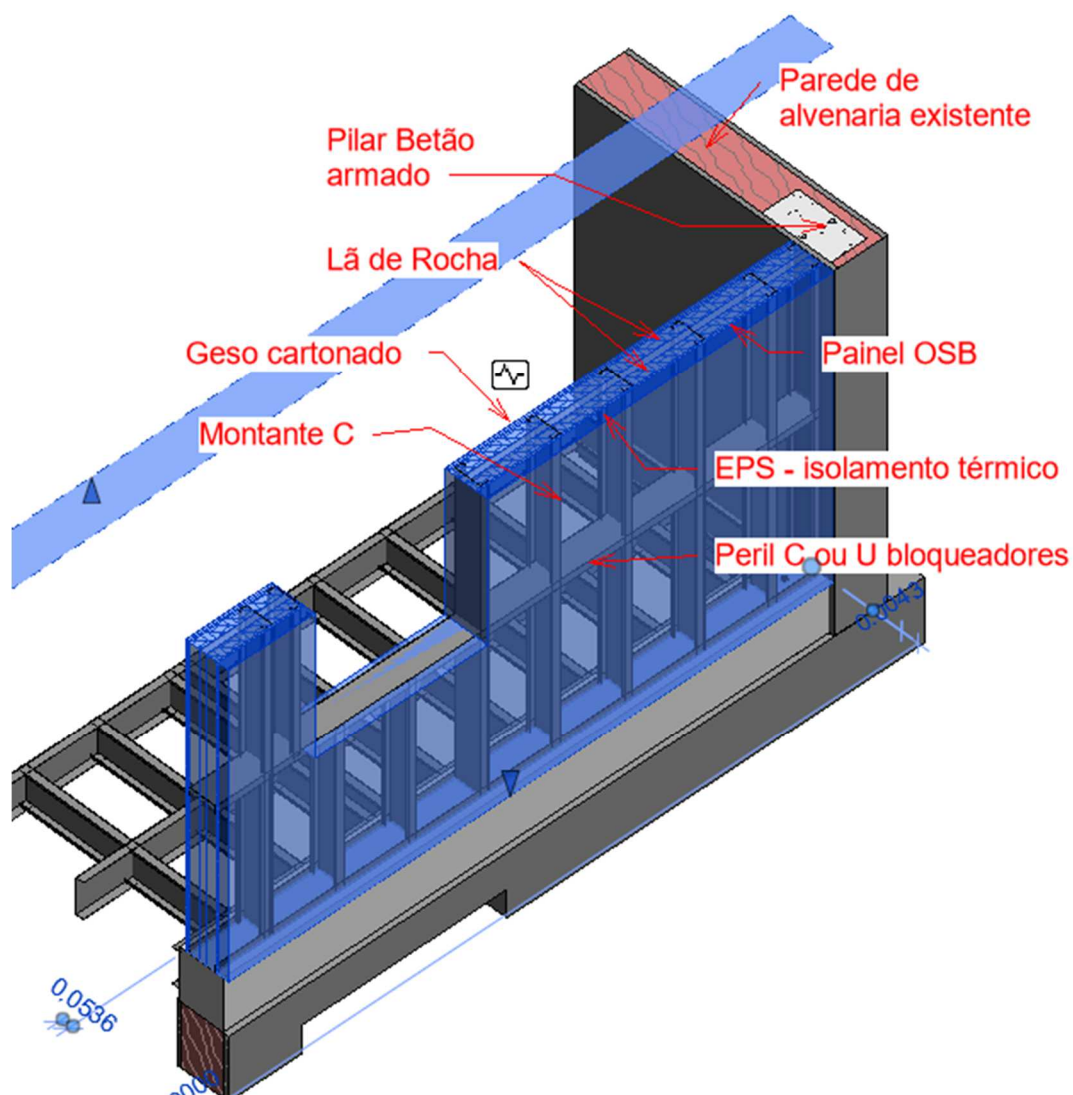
Conjunto Parede, Montantes e painéis de revestimento
